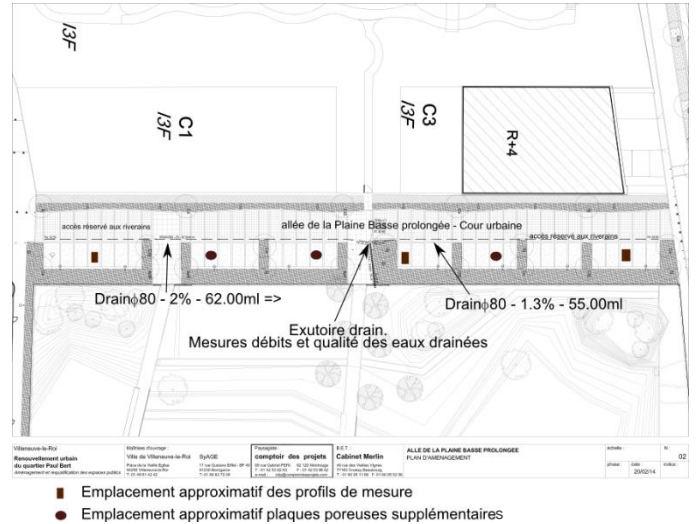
Plan d'aménagement et d'instrumentation du parking de Villeneuve-le-Roi
